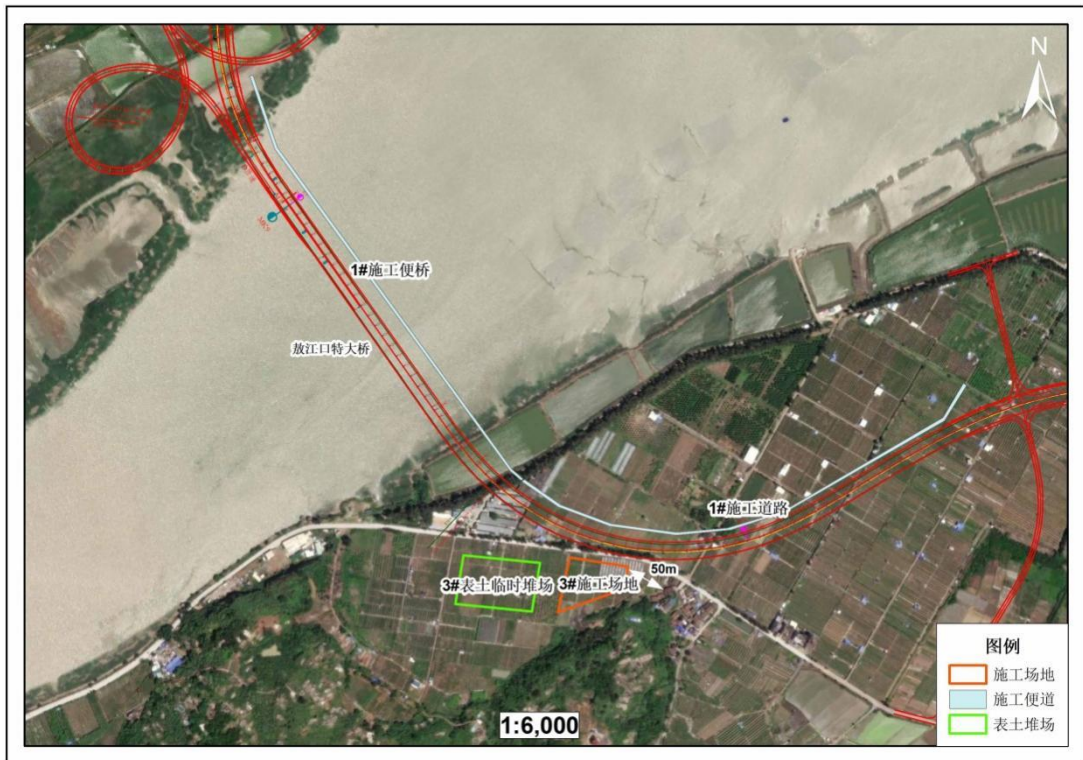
临时工程平面布置示意图（1#便桥和道路、3#表土堆场和施工场地）
